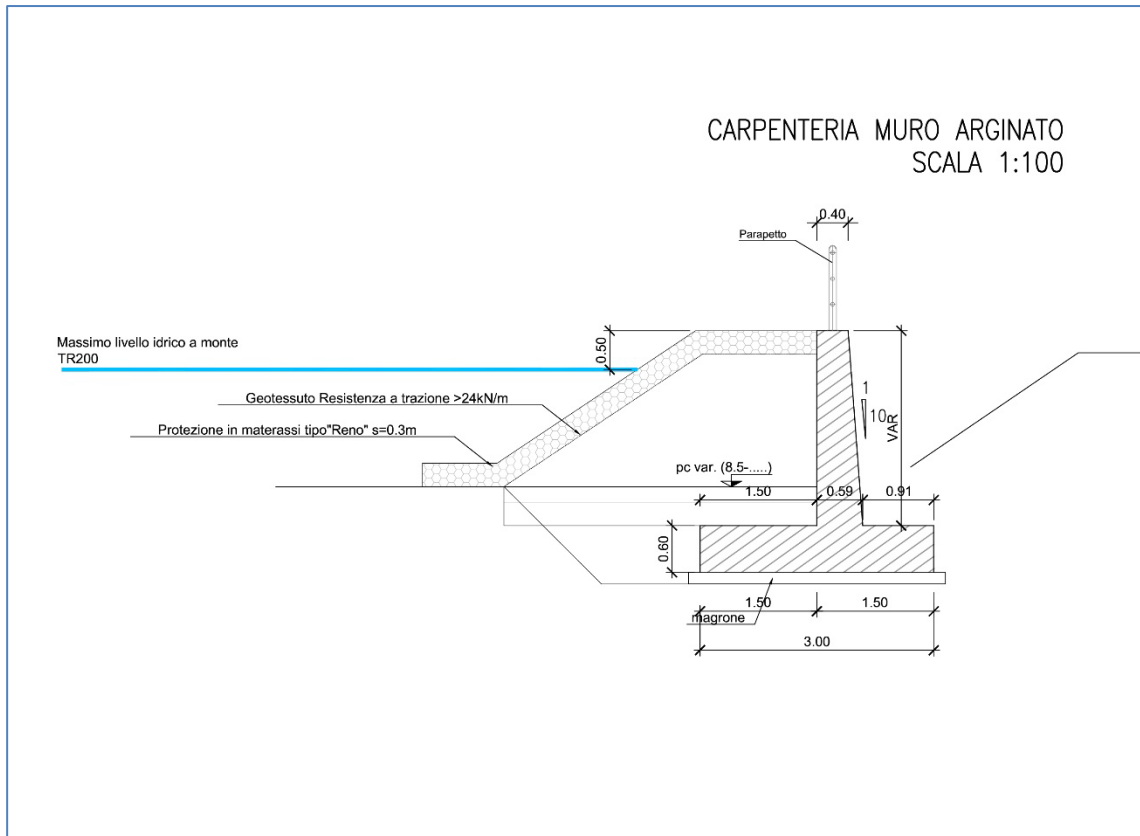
Muro di difesa dagli allagamenti della zona di Fontanarossa (a monte della linea Ferroviaria) – sezione tipo
